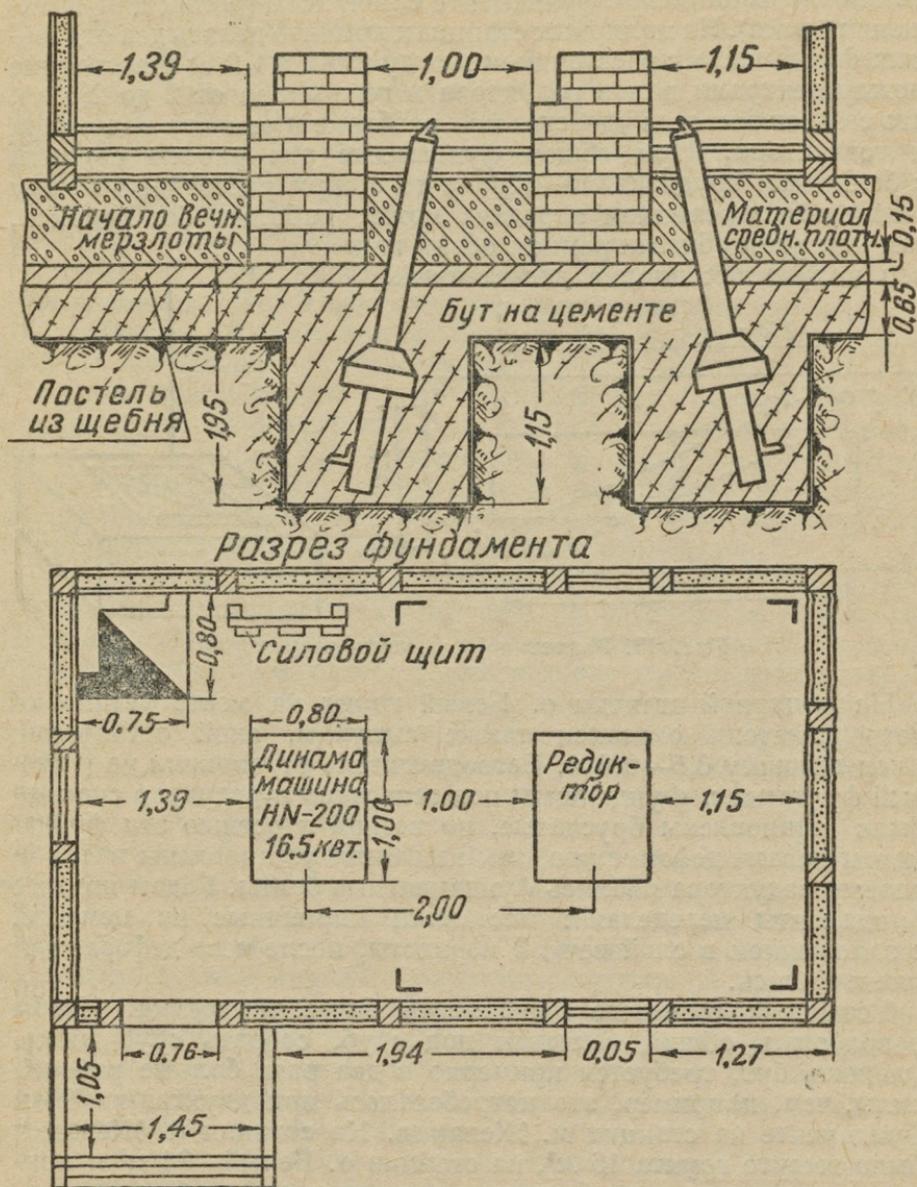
Разрез фундамента и план здания ветродвигателя Д-12 на полярной станции м. Желания
